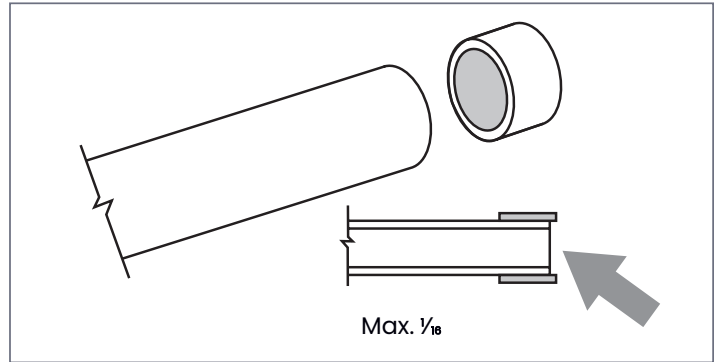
Glisser la bague dilatée sur l'extrémité du tuyau
